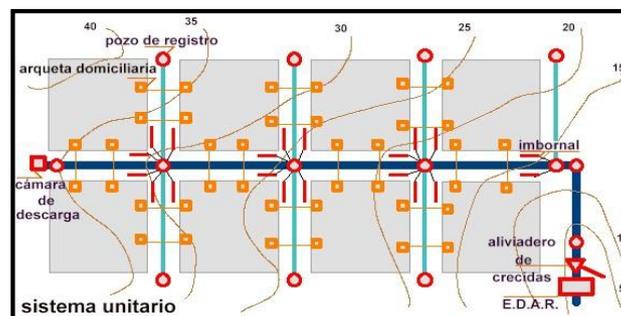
Sistema de alcantarillado combinado. Fuente: www.google.com
